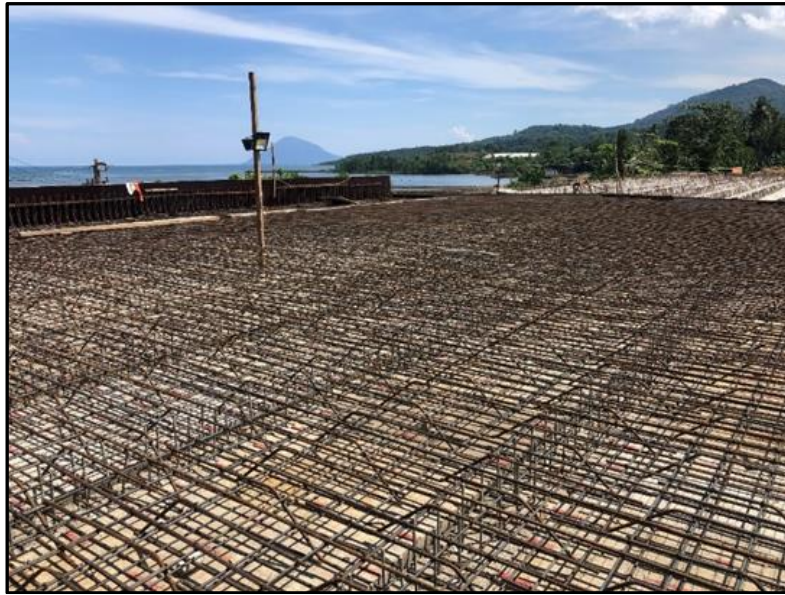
Pemasangan Playwood (Bekisting Trotoar)
